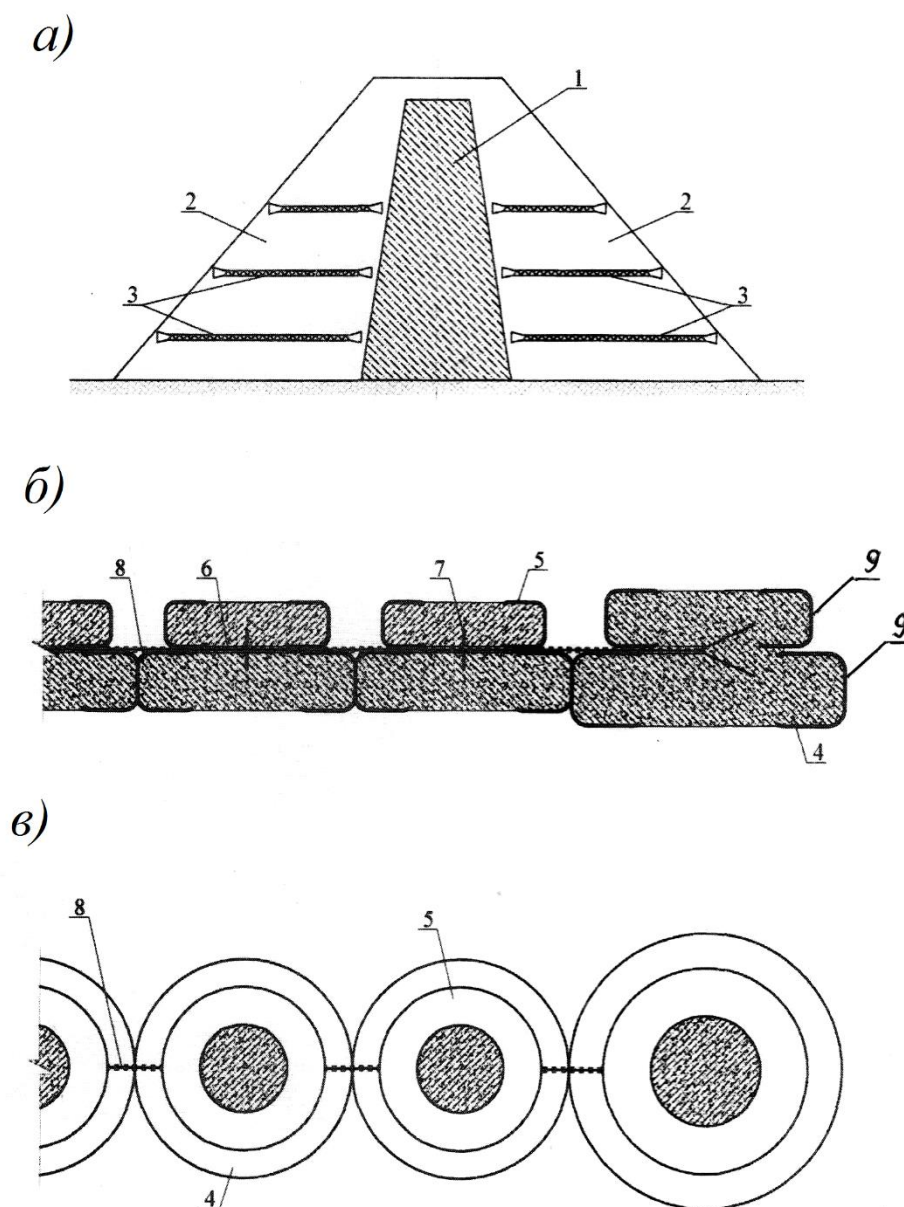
Сейсмостойкая грунтовая плотина с армирующими элементами:
